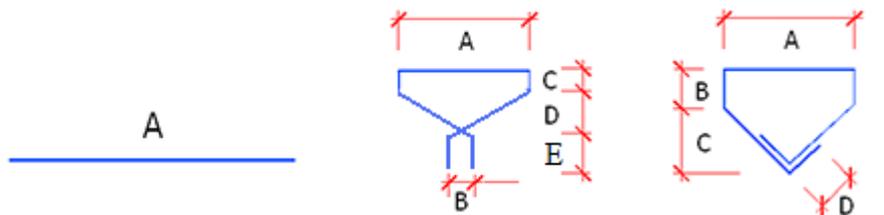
Tipos de armaduras en el ala superior.
